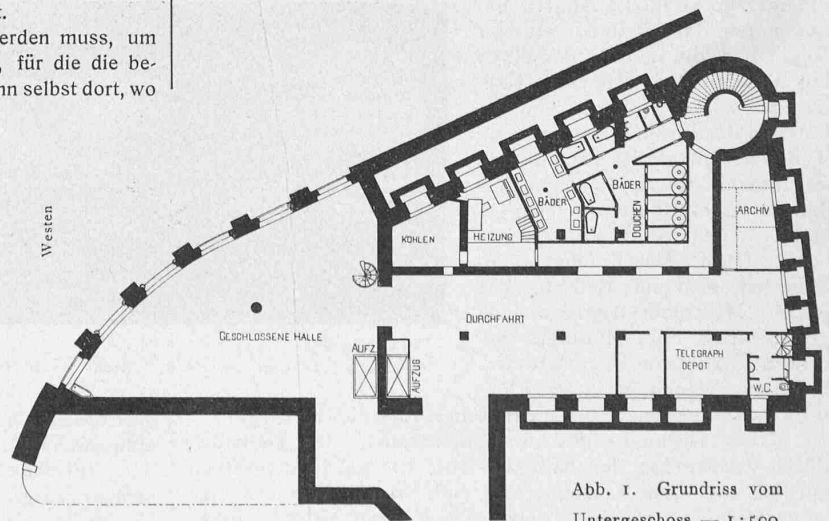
Grundriss vom Untergeschoss. — 1 : 500.
